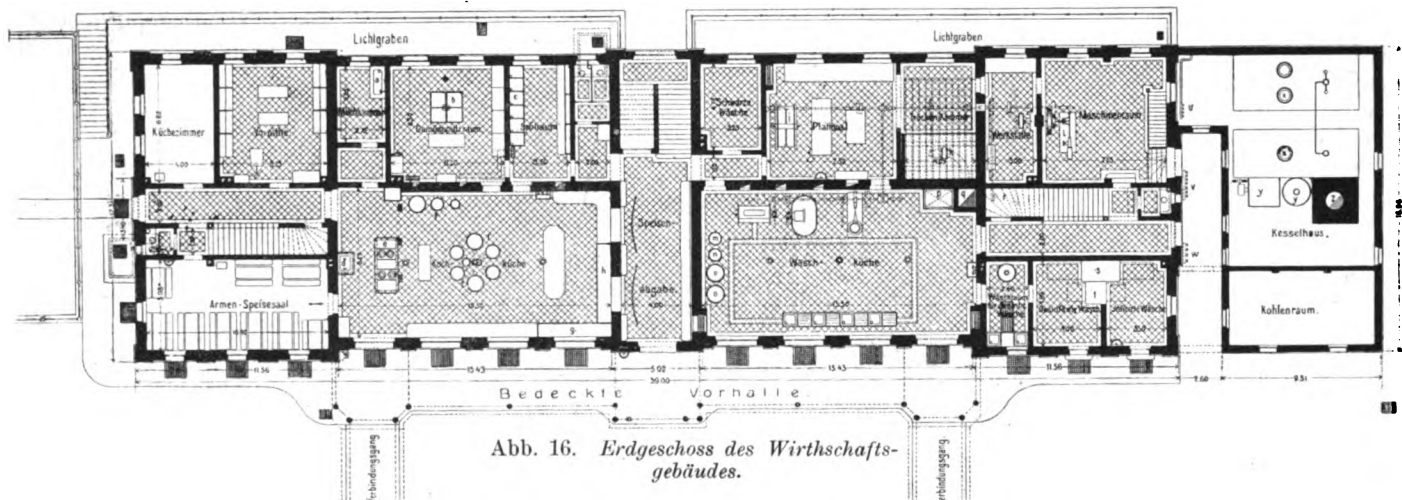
Erdgeschoss des Wirthschaftsgebäudes.
